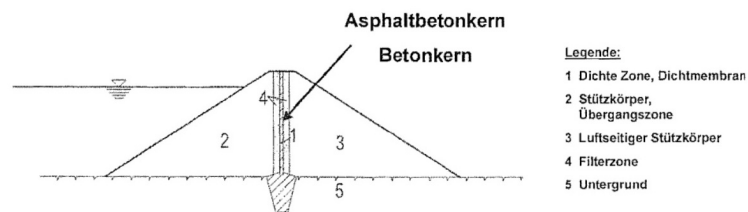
prinzipieller Aufbau, Damm mit membranartiger Innendichtung aus: [28]
